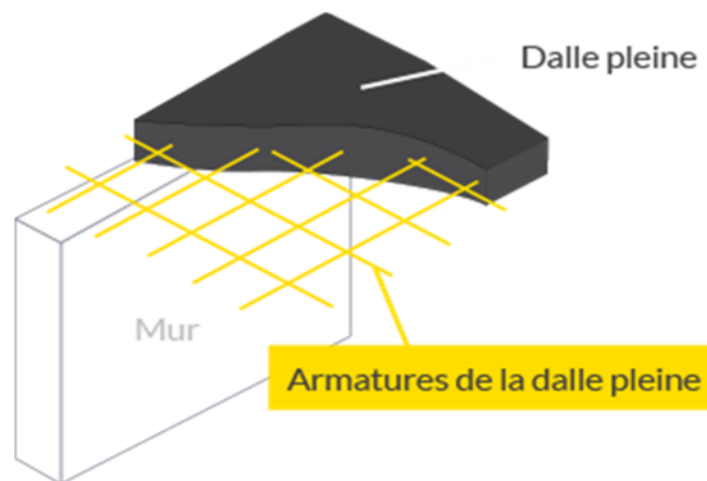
Schéma illustratif d'une dalle pleine.
